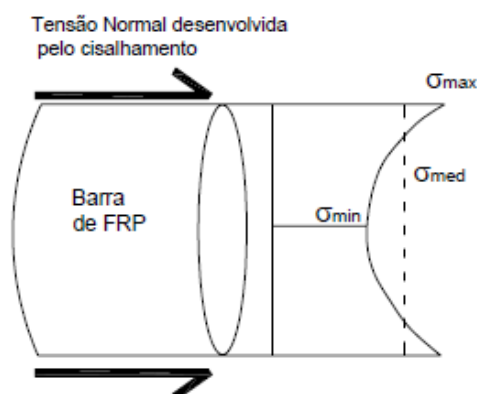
Distribuição de tensão normal em uma barra GFRP sobre carregamento axial. (ACHILIDES E PILAKOUTAS, 2004)
